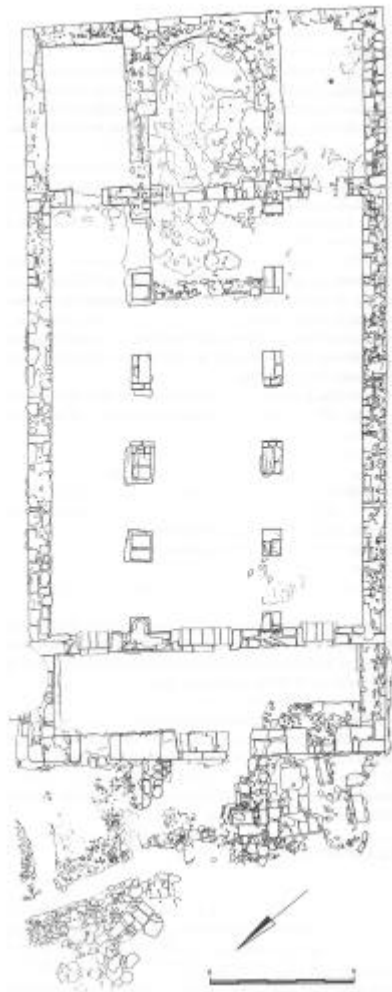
Planta de la basílica de Son Bou (según Orfila y Tuset, 1988)
